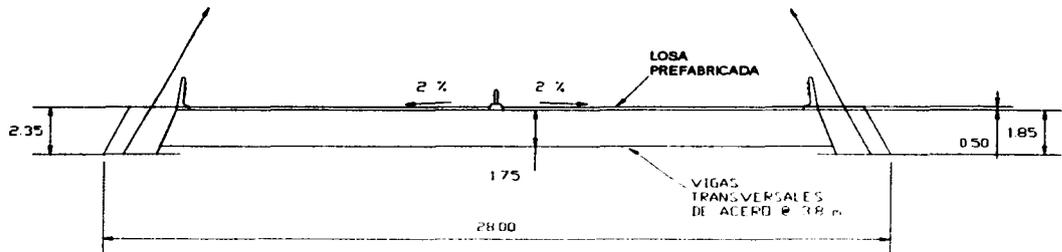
Sección transversal para el puente Sunshine Skyway (E. U.), estructura mixta
